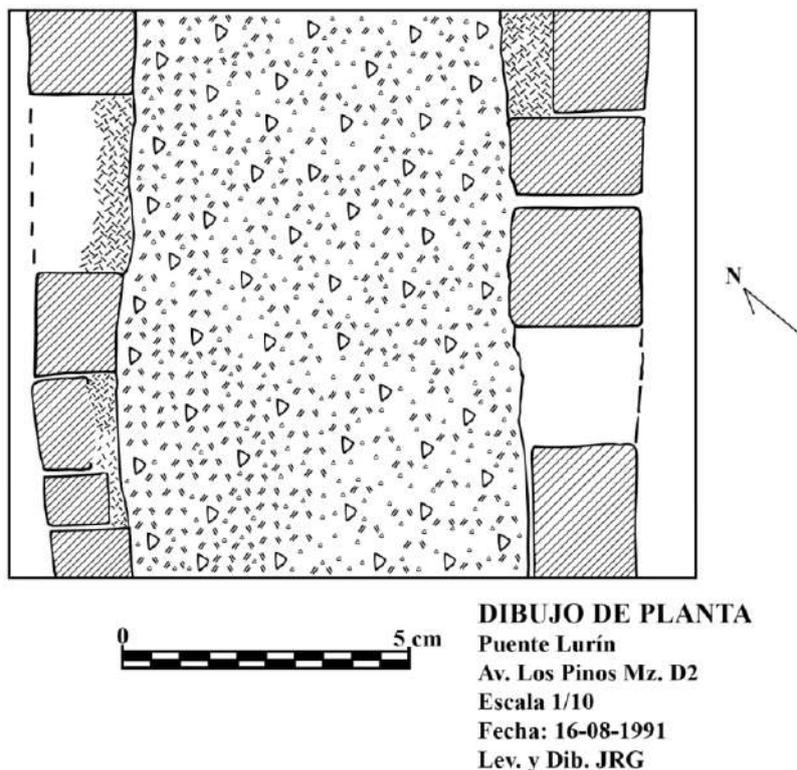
Planta de un muro de piedras canteadas unidos con argamasa de barro, el interior del muro está relleno con cascajo. Dibujo J. Ramos.
